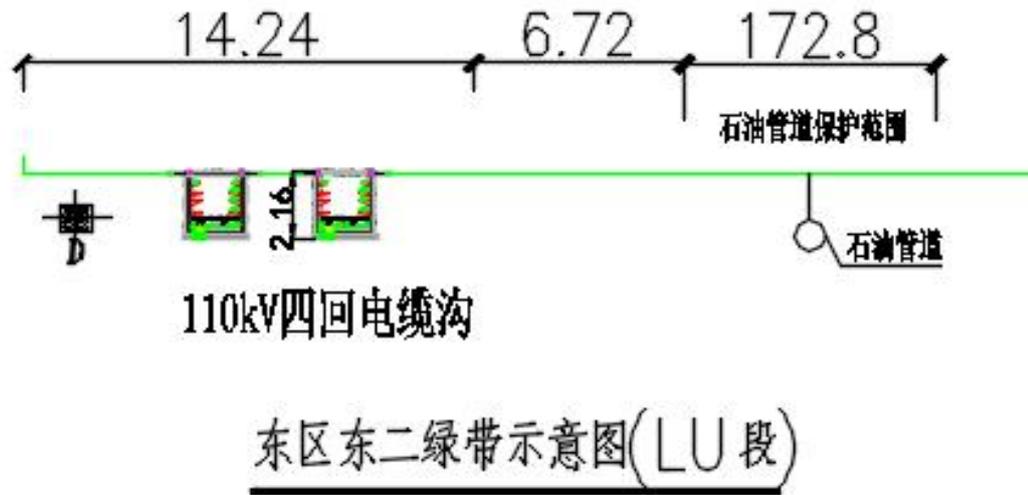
东区东二绿带示意图（LU 段）电缆沟断面图
